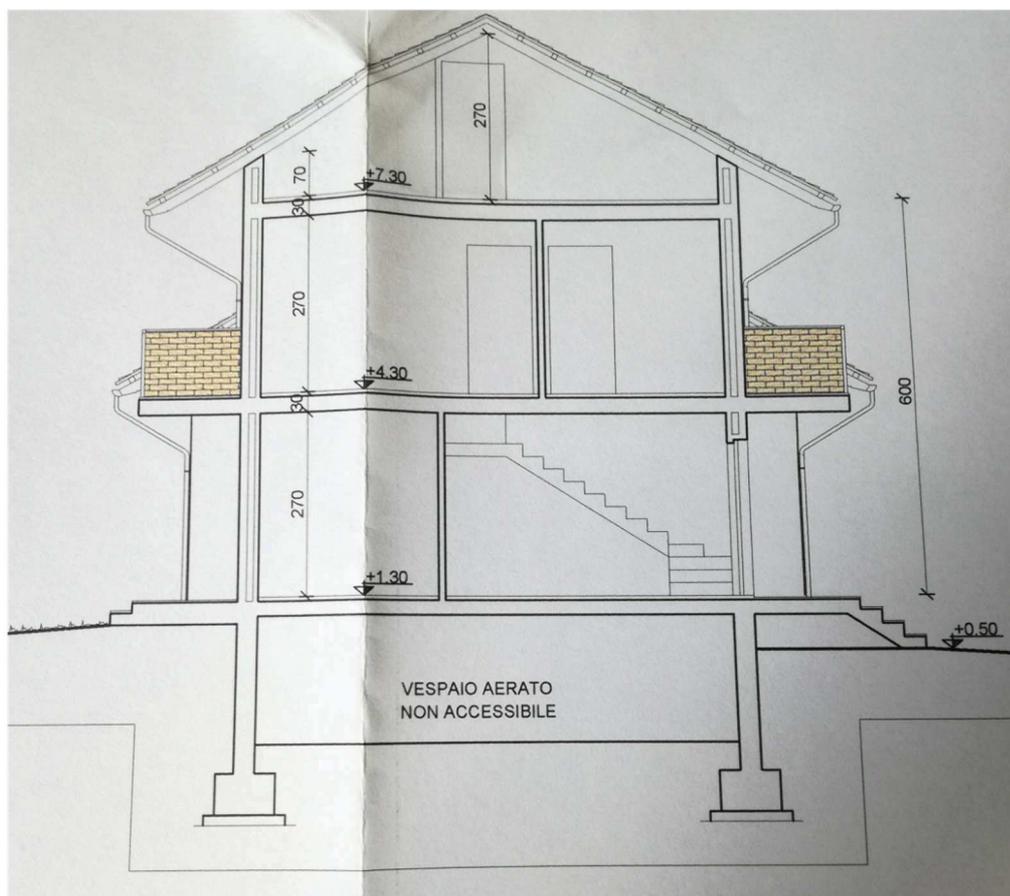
Sezione trasversale edificio trifamiliare situato in frazione Mezzi Po
